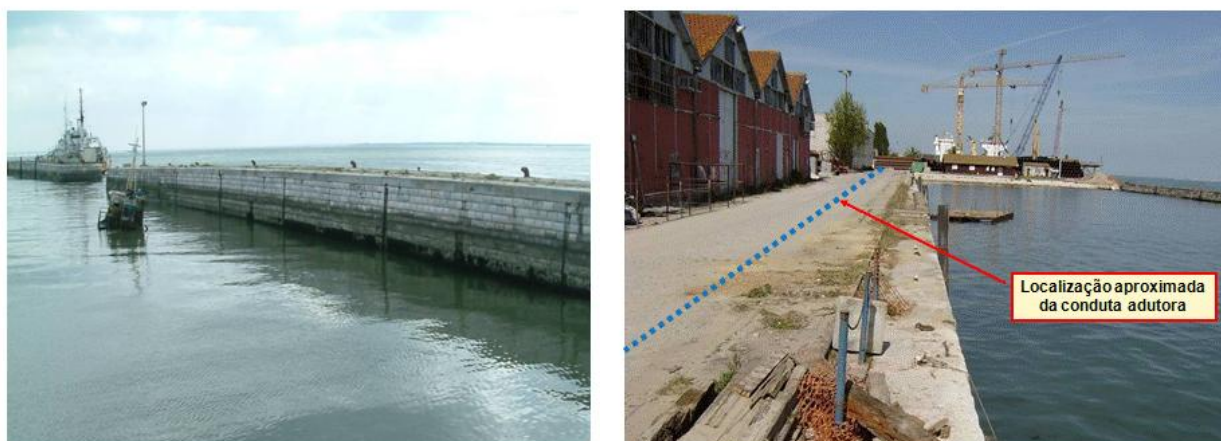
Vista das Estruturas e Infraestruturas adjacentes ao Recinto da Intervenção
